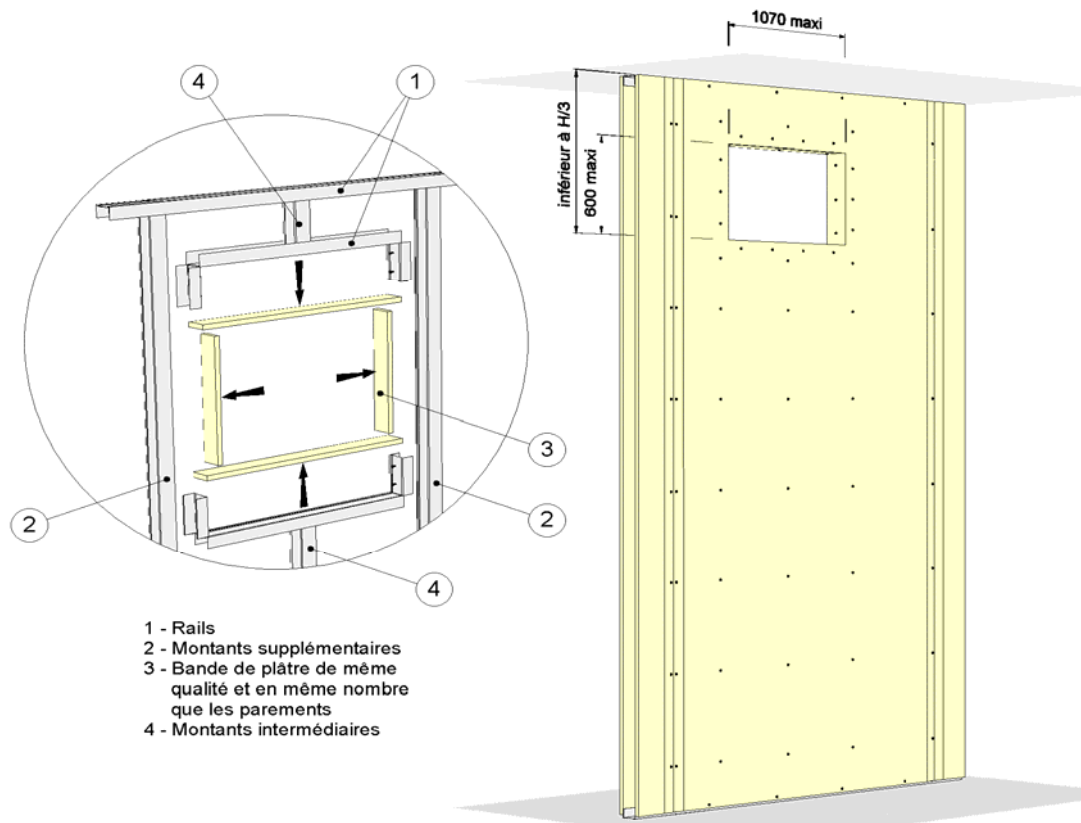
Cas des réservations de section carrée ou rectangulaire
